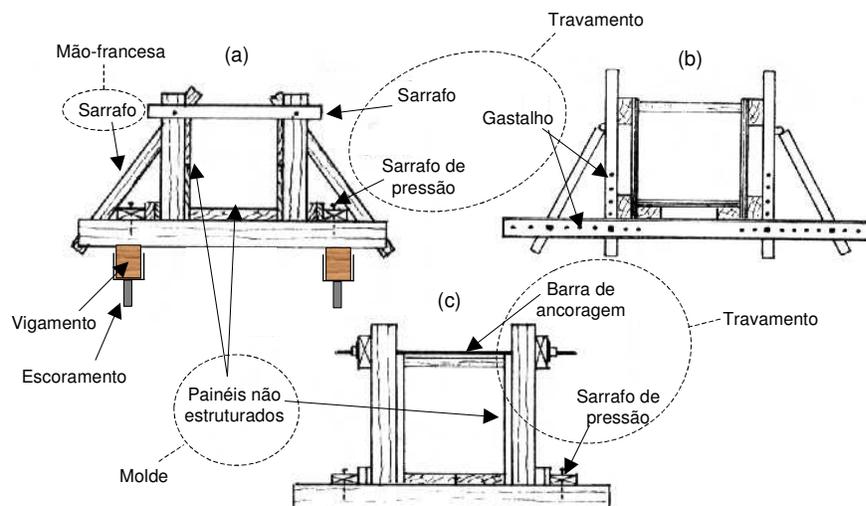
Diferentes tipos de estruturação e travamento do molde de viga: a) painéis não estruturados em tábuas, mão francesa em sarrafo e travamento com sarrafo pregado na parte superior e sarrafo de pressão; b) painéis em chapa de compensado estruturados com sarrafos e travamento com gastejo metálico; c) painéis em tábua estruturados com pontaletes e travamento com sarrafo de pressão e barra de ancoragem (Adaptado de PETERS, 1991).
